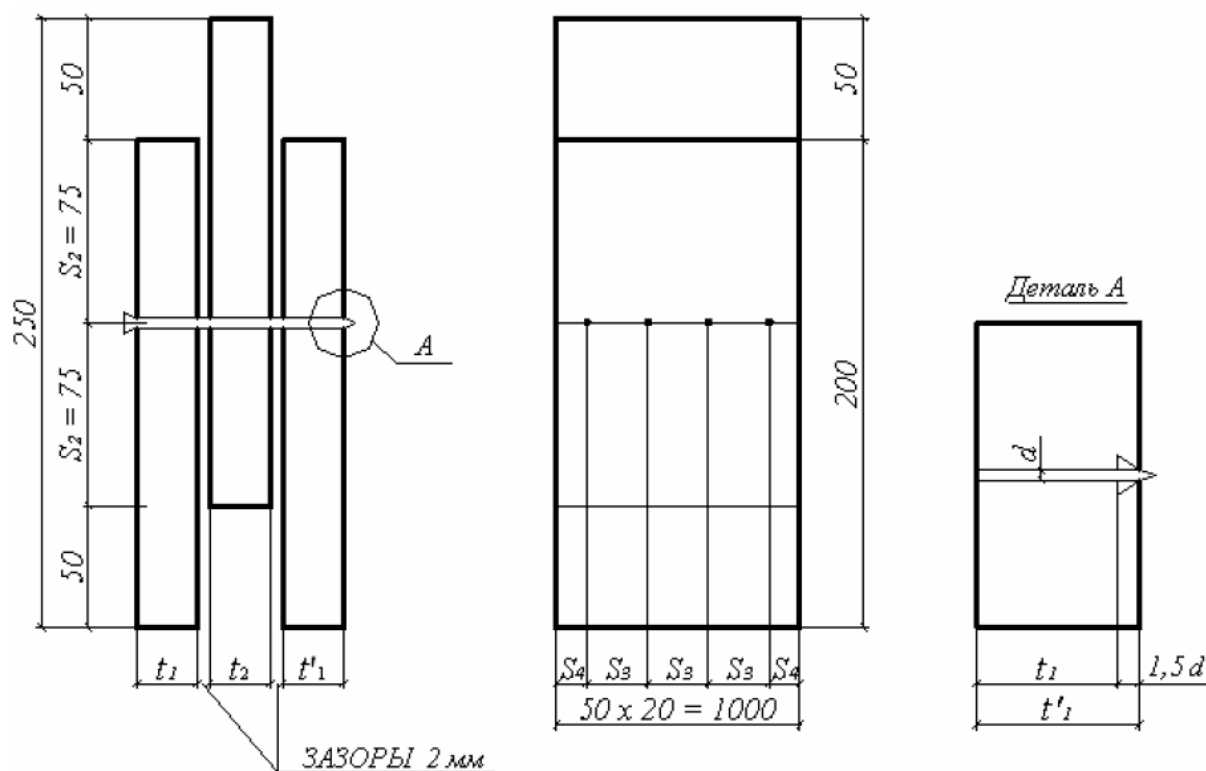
Расчетная схема разрушения нагельного соединения
